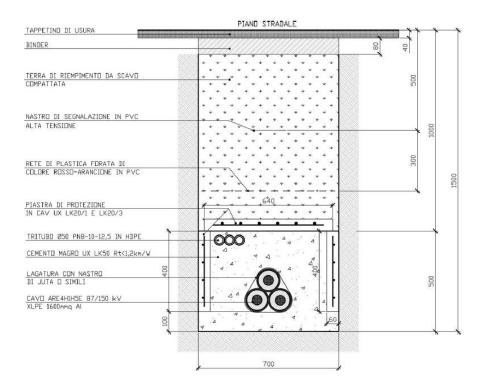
Sezione del cavidotto AT tipo sotto la strada
